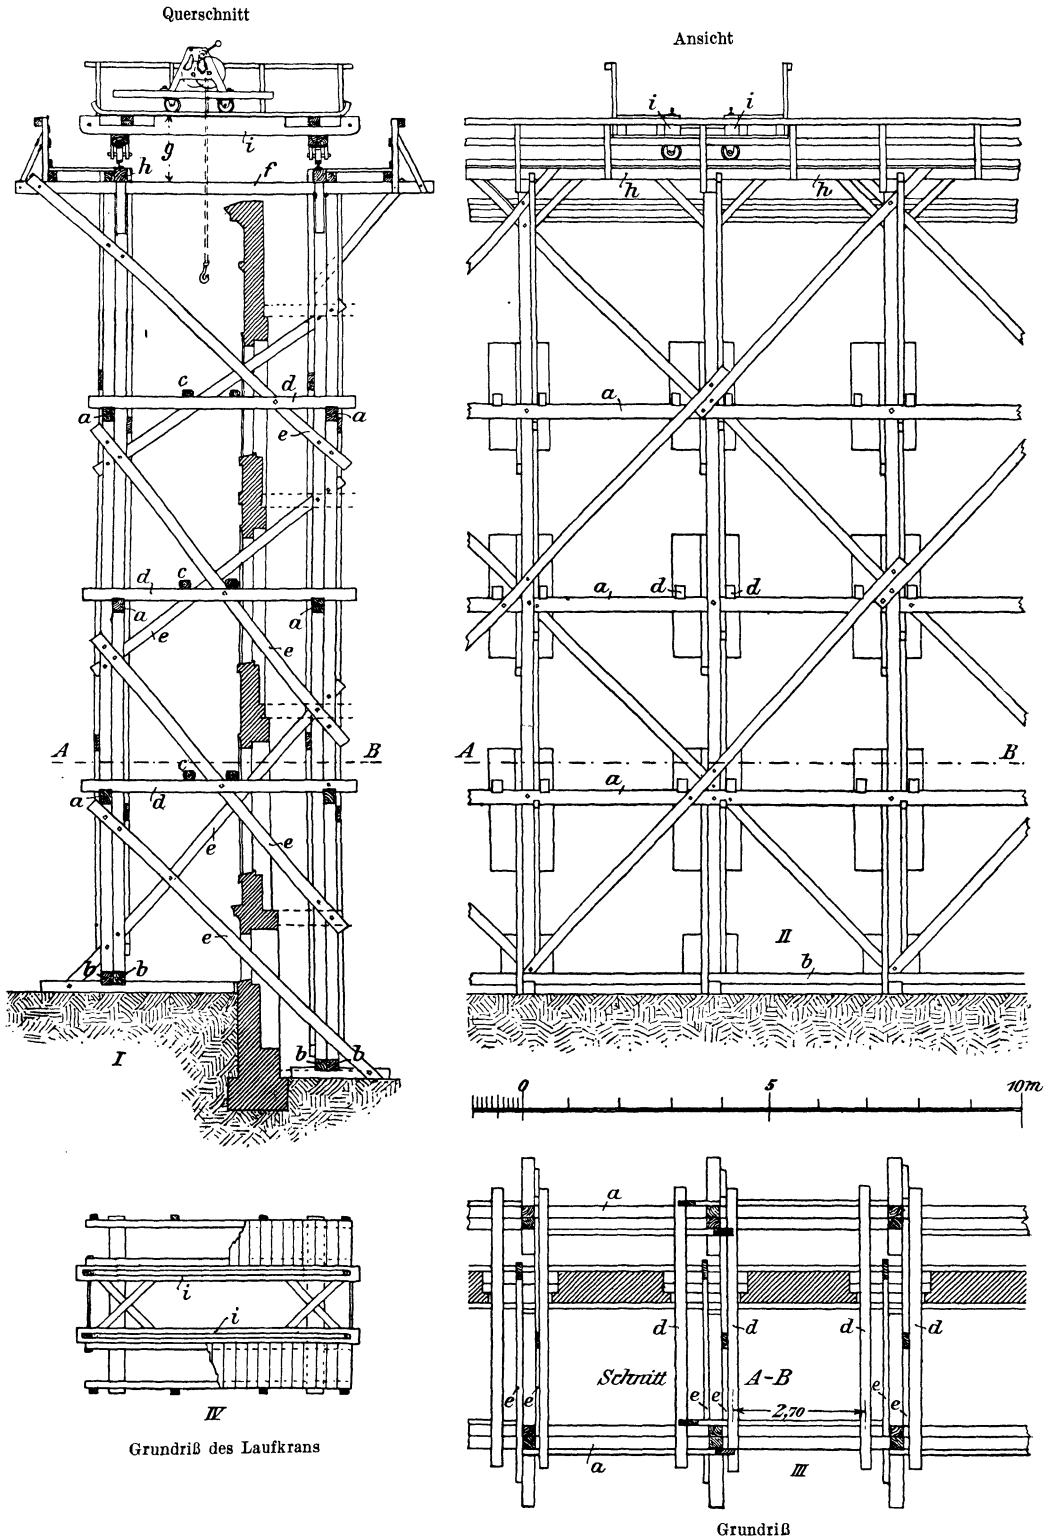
Abgebundenes Standgerüst mit oberem Laufkran.
